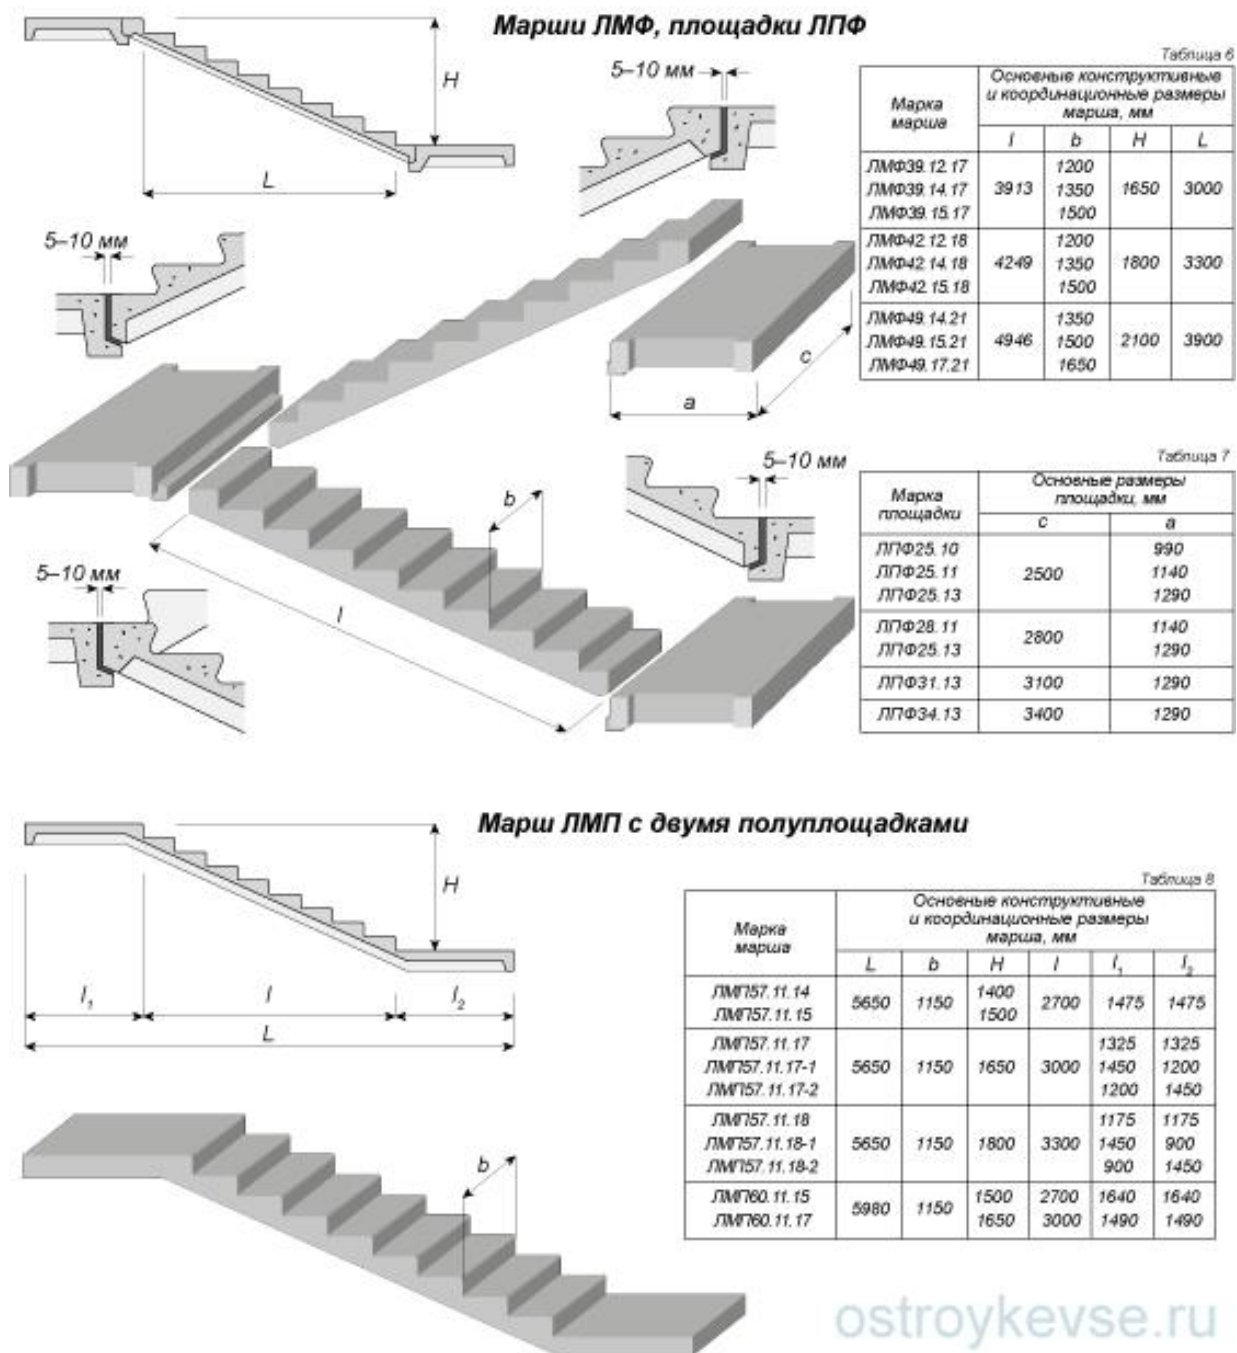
Общий вид и основные характеристики сборных железобетонных элементов лестниц.
